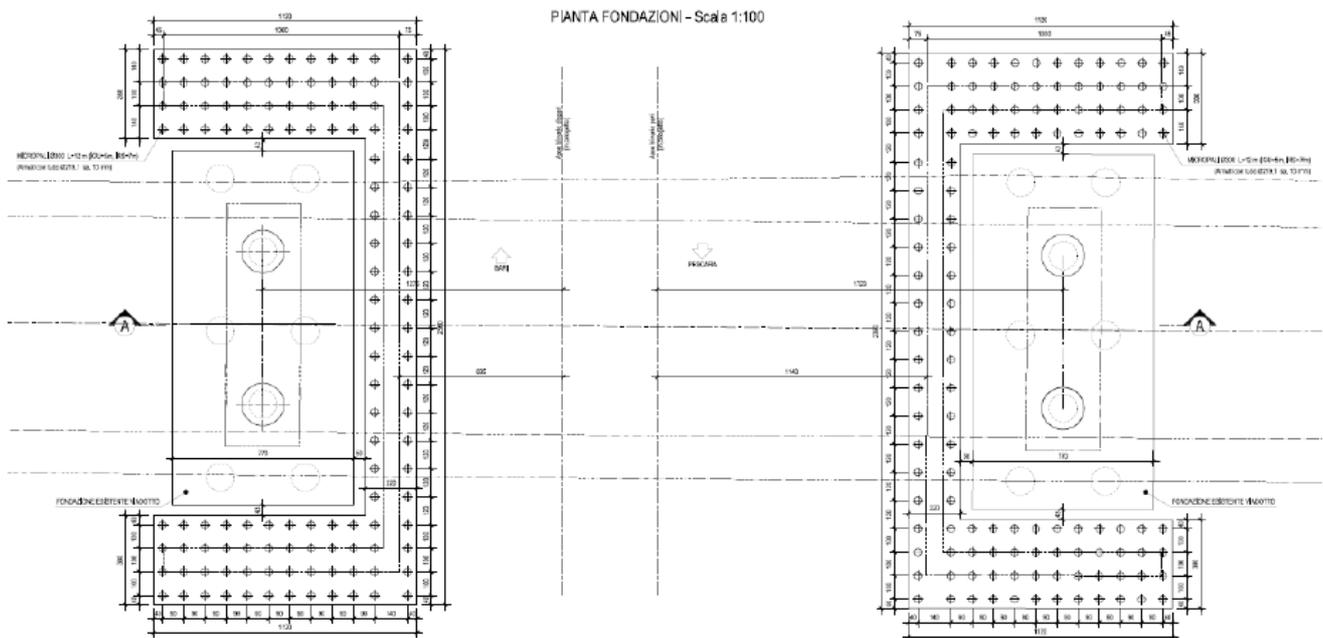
Vista planimetrica dell’opera di protezione bretella SS16/SP31
